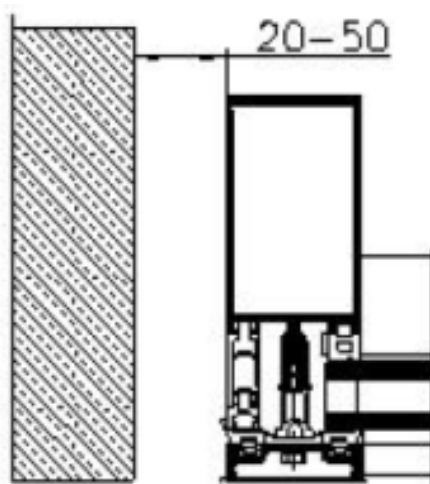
Размеры монтажных зазоров (швов) при установке алюминиевых конструкций
